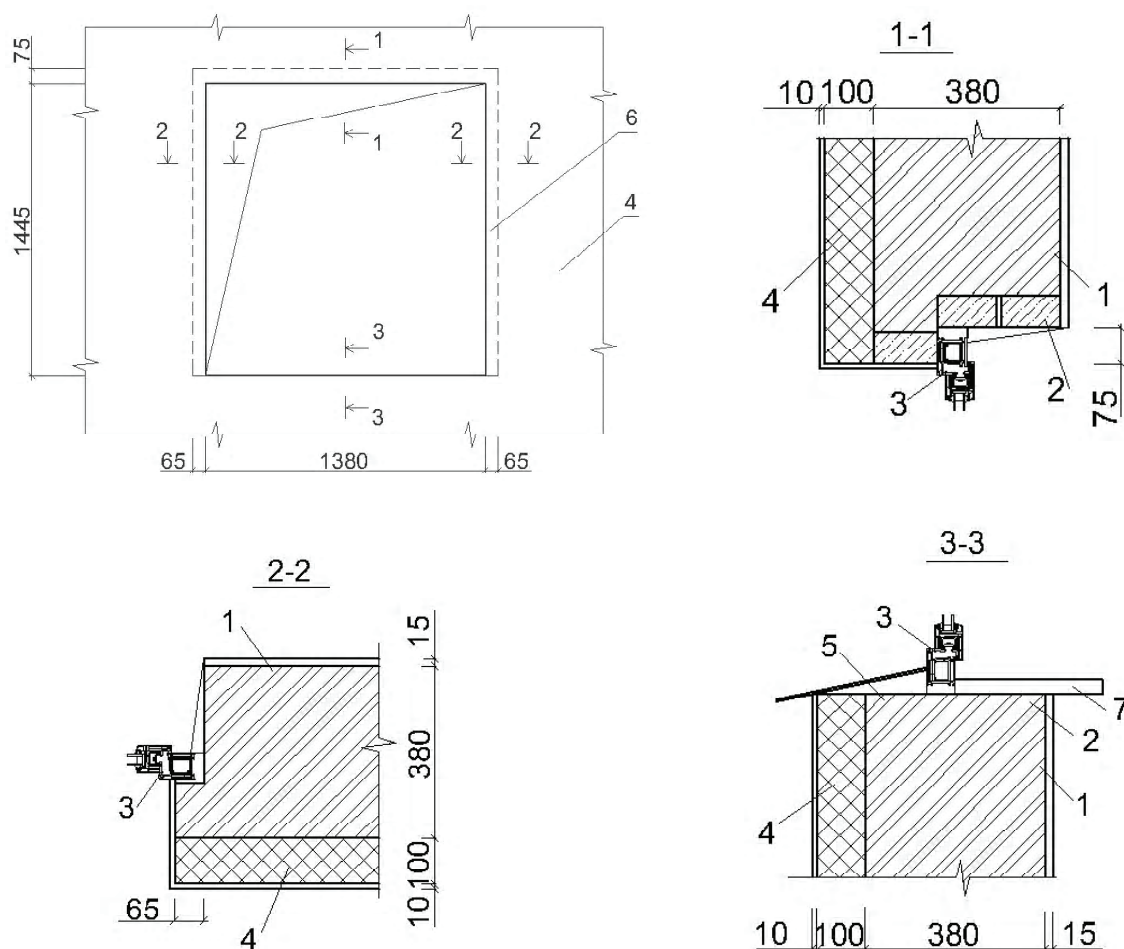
Конструктивное решение оконного проема с четвертью: 1 – наружная кирпичная стена, 2 – железобетонная перемычка, 3 – оконное заполнение, 4 – внешняя теплоизоляция, 5 – слив, 6 – подоконник.
